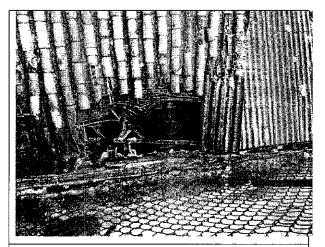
Aspecto general de la cubierta zona posterior (costado norte) de la edificación emplazada en el predio de la Calle 8 No. 0-20. Se observan colapsos y deformaciones estructurales importantes.
